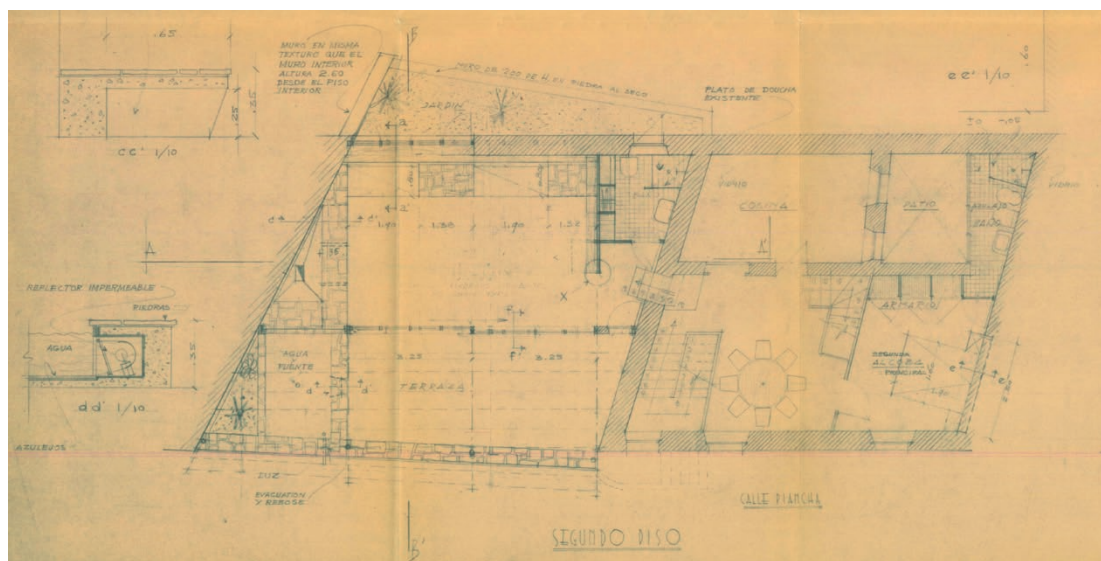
Planta original de la casa donde aparece el gran living junto con algunos detalles constructivos del mobiliario de obra y el estanque de agua.
